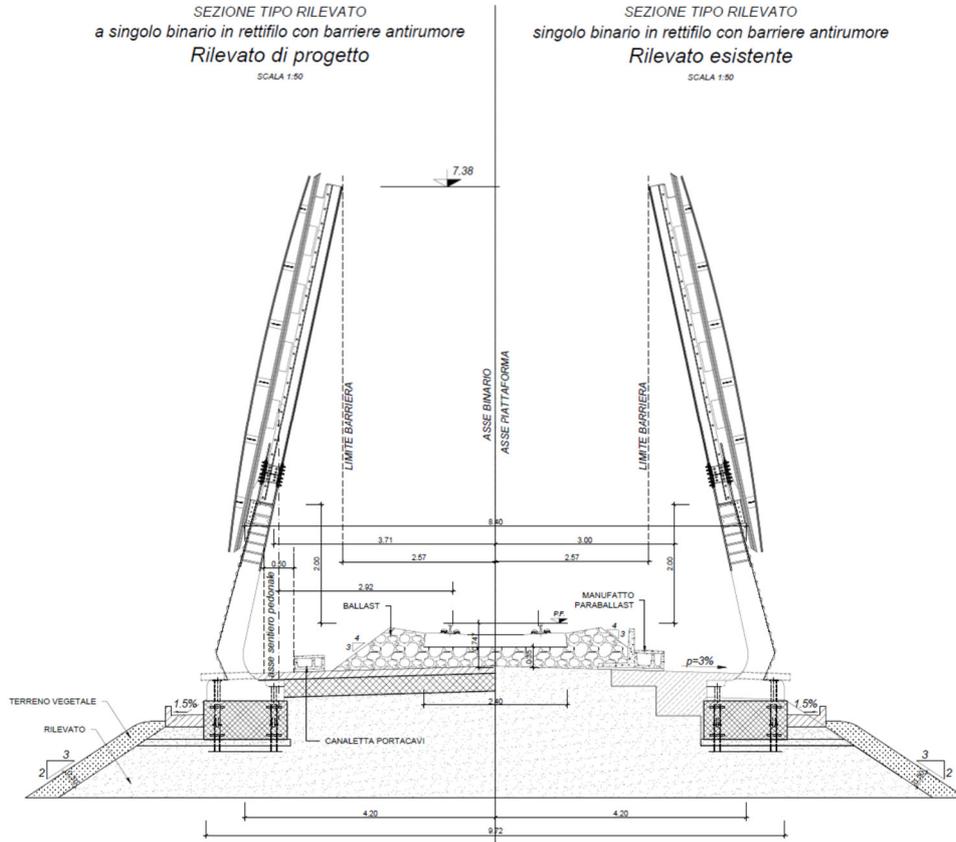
Sezione tipo in trincea a singolo binario con barriere antirumore, installazione su nuovo rilevato e su rilevato esistente
